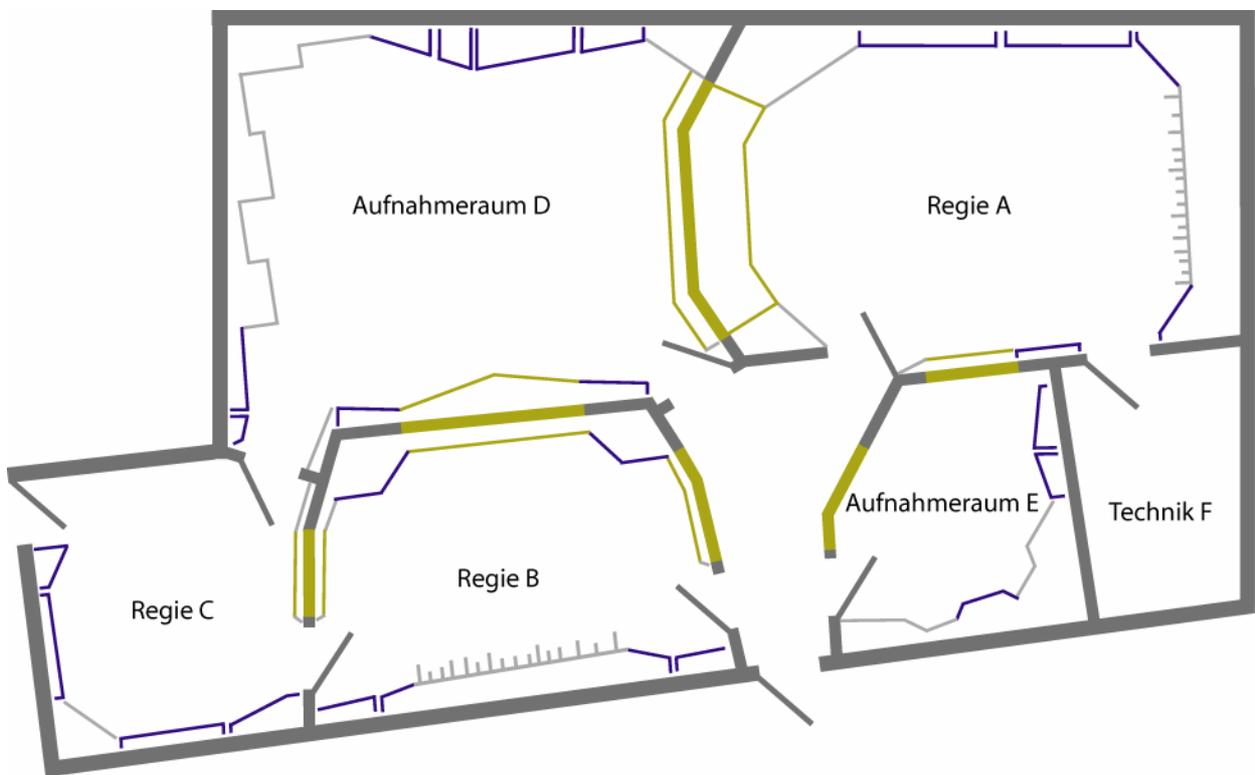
Grundriss des Tonstudiokomplexes mit akustischen Bauelementen
